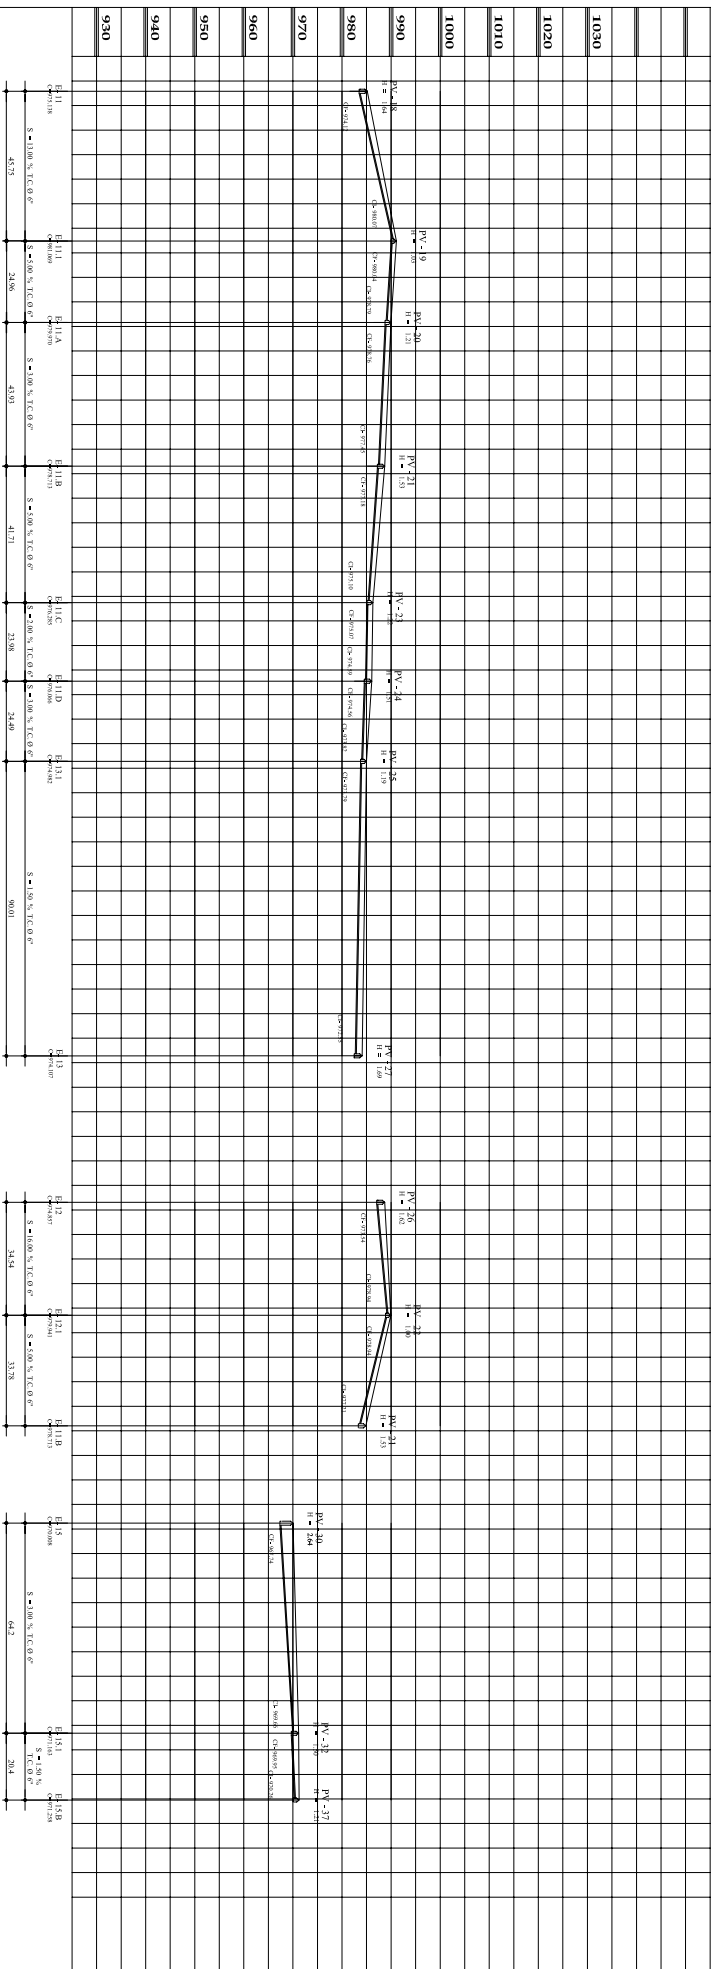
Planta, perfil alcantarillado sanitario Aldea El Chagüite
